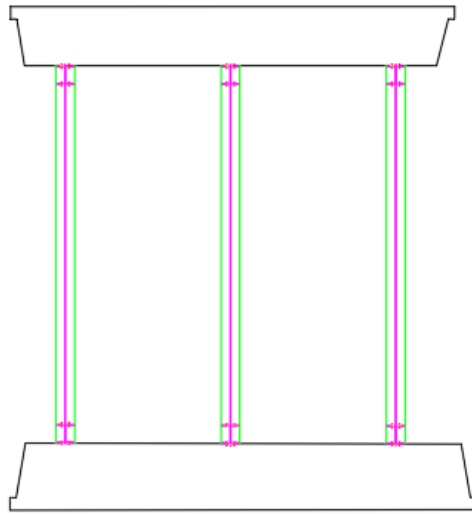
schema tipo pianta del portale in acciaio
